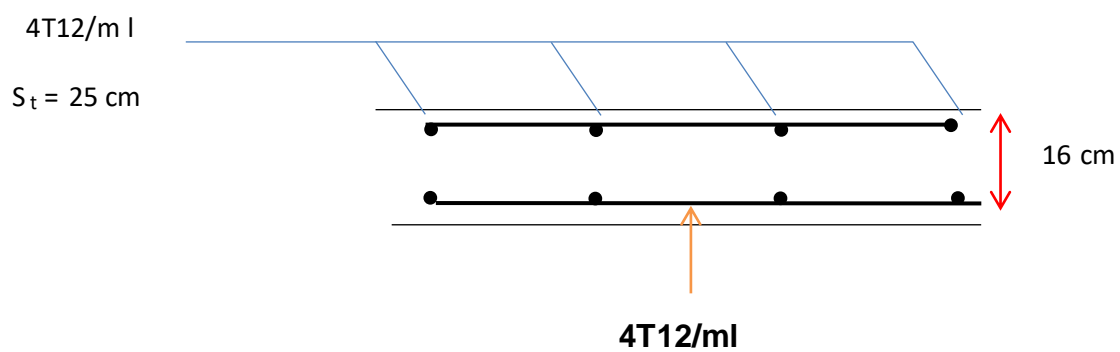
Ferrailage de dalle pleine pour une bande de 1 m.
